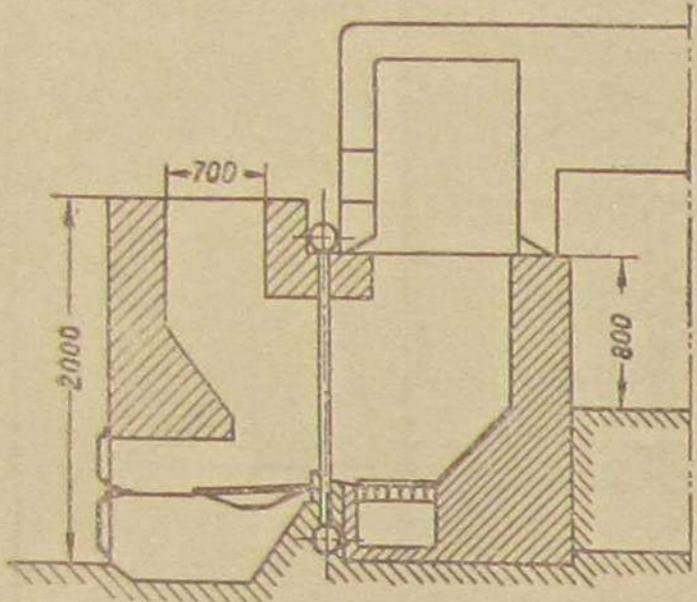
Схема топки скоростного горения для торфа в компоновке с локомобильным котлом без золового подвала.
